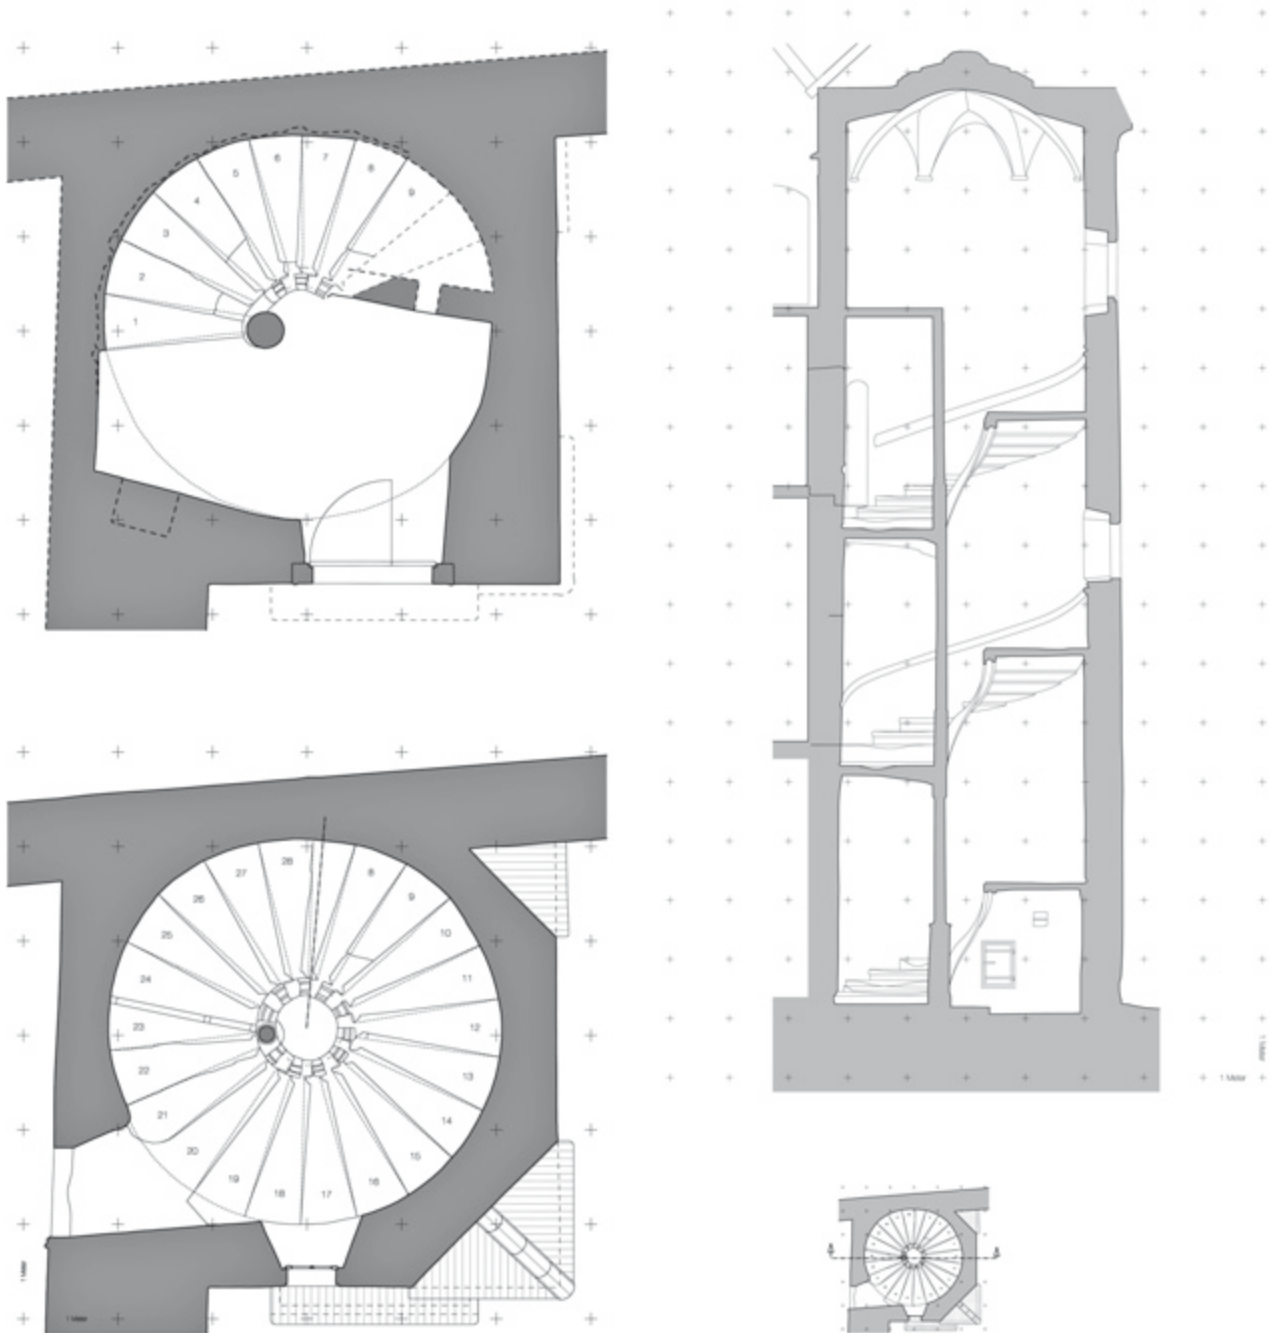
Orth an der Donau, Schloss. Hohlspindeltreppe mit einer Wangensäule, kurz nach 1548. Grundriss Erdgeschoß und 1. Obergeschoß, Schnitt.
